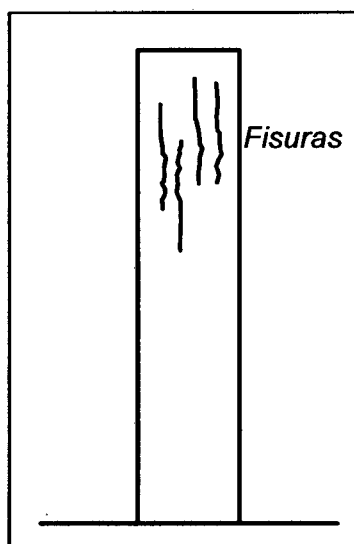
Fisuración longitudinal en columnas por compresión (Pérez, 2008)
